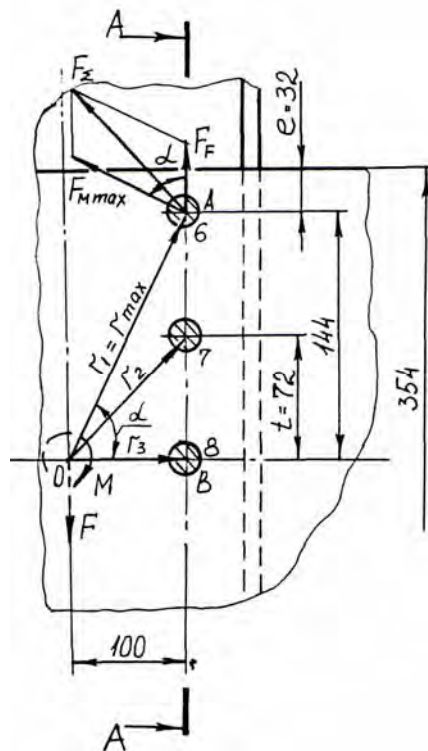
Элемент чертежа заклепочного соединения косынки со швеллером
